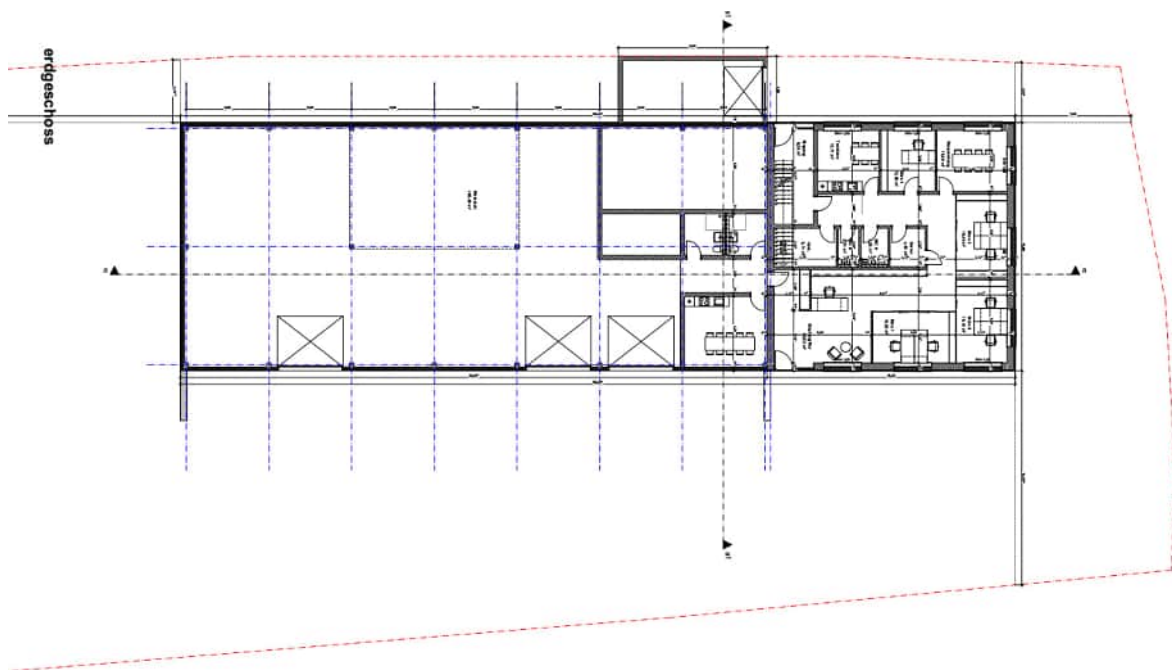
Auszug der Grundrissplanung des Erdgeschosses
